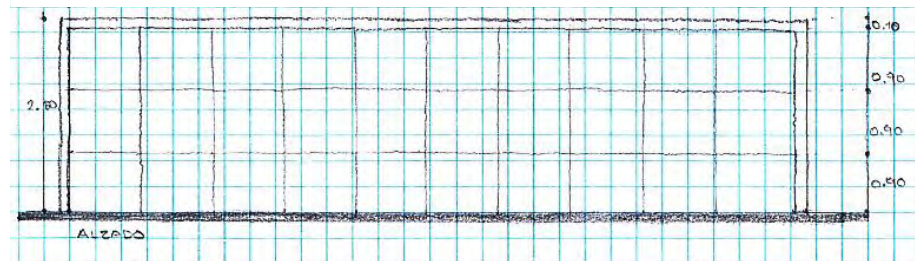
Gavetas con dimensiones en alzado (dibujo propio)
